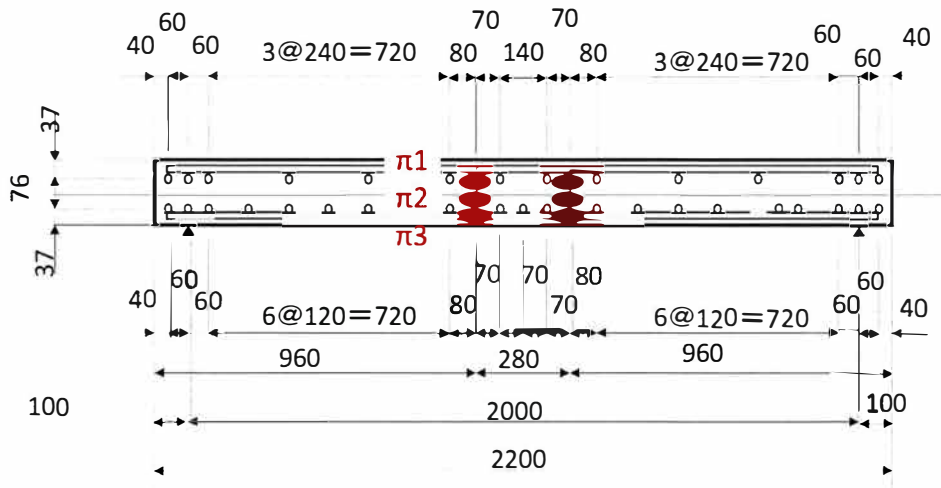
曲げ試験供試体 Π ゲージ設置位置
